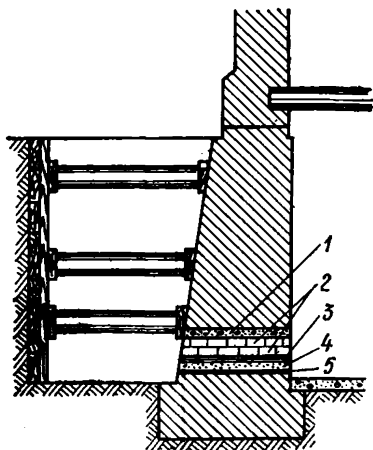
Замена или устройство вновь нижней горизонтальной гидроизоляции в здании с подвальным помещением
